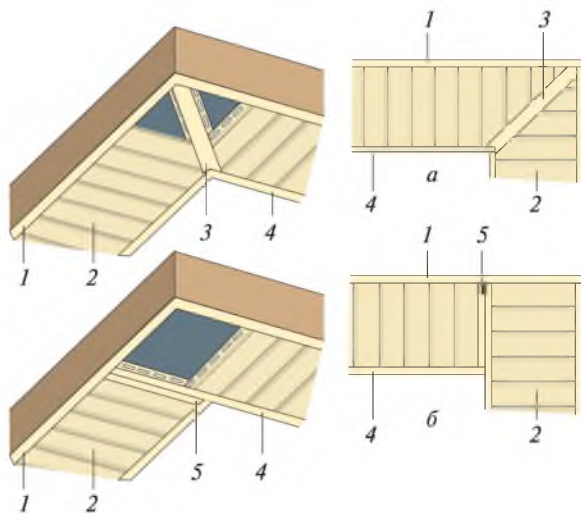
Соединение софитных подшивок на углах: а — на косой угол; б — на прямой угол; 1 — карнизный принимающий профиль; 2 — софит; 3 — Н-профиль или два J-профиля; 4 — пристенный принимающий профиль; 5 — J-профиль
